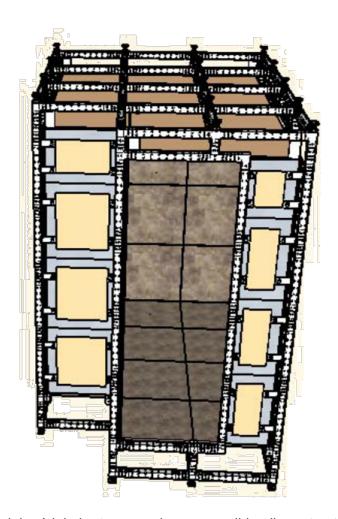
Adaptación del módulo baño a esquina con posible pilar estructural.
